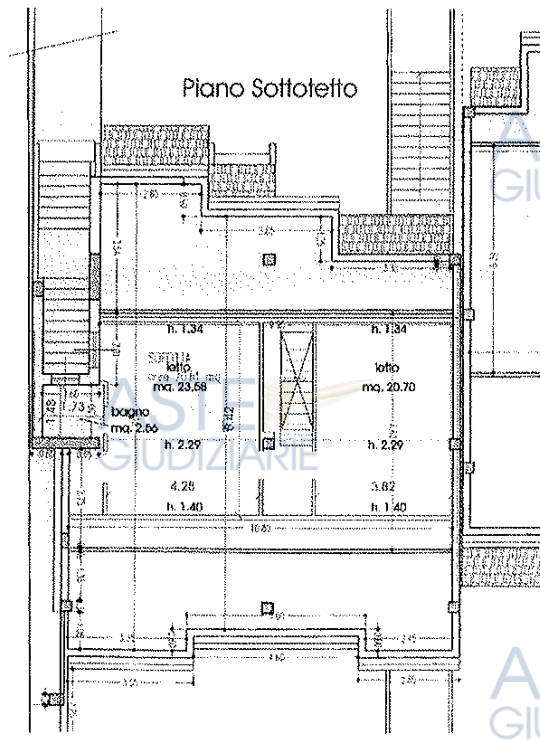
Piano sottotetto - sovrapposizione stato attuale con i disegni della Concessione edilizia
